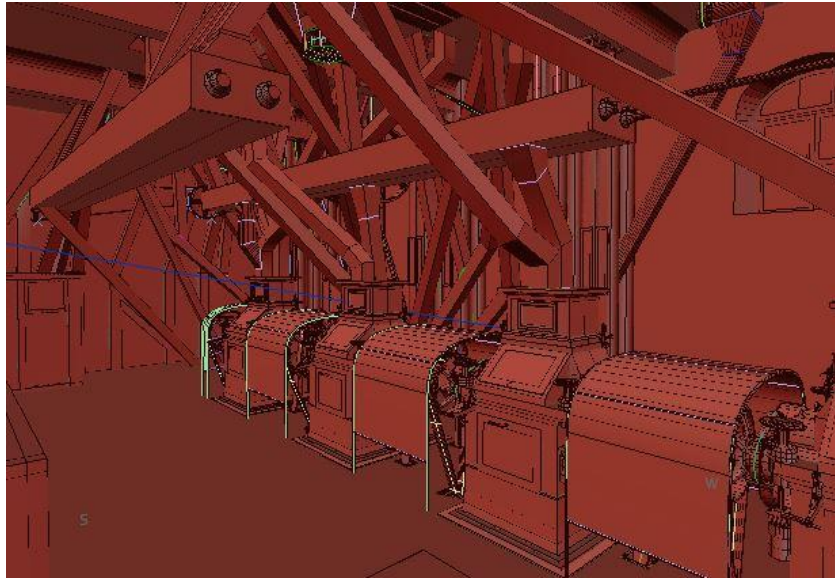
Vista general de las canalizaciones del ala sur de la planta primera.
